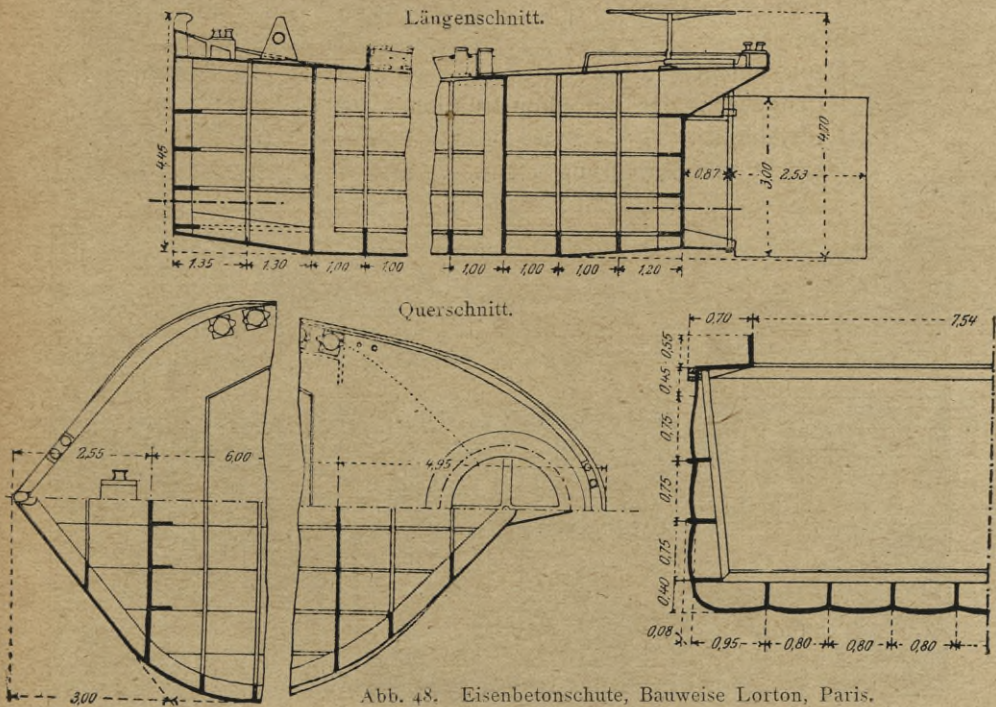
Eisenbetonschute, Bauweise Lorton, Paris.
